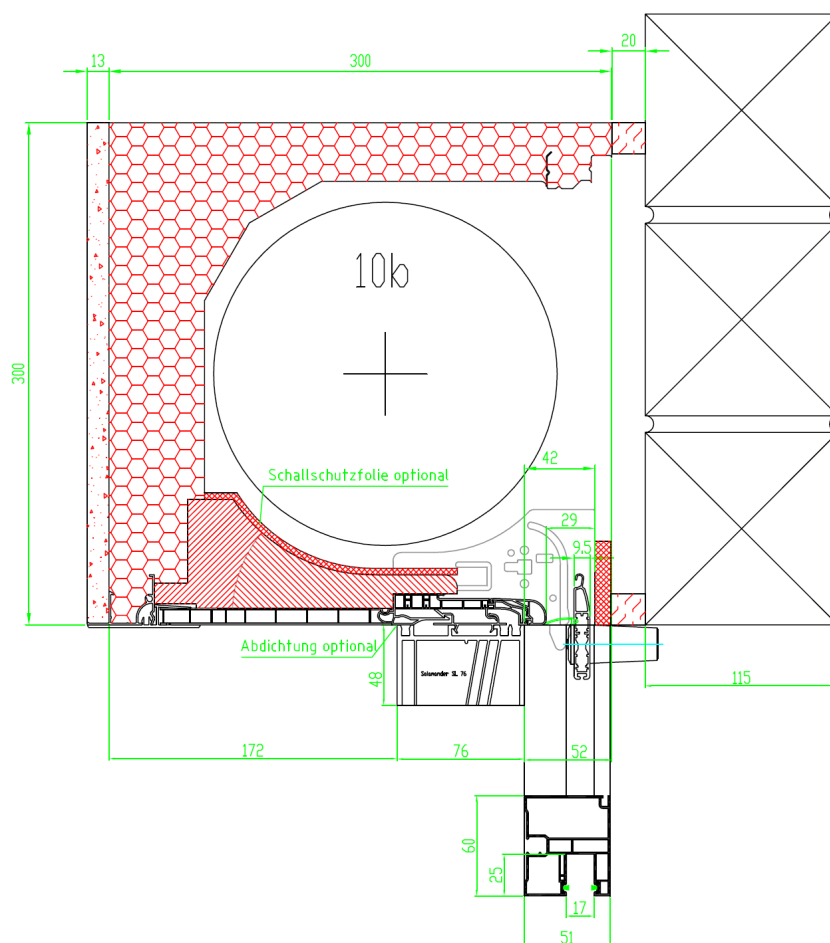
Schnittzeichnung (Grundsatzdetail, Ausführung mit Schallschutzfolie, ohne Abdichtung zum Fensterrahmen, simulierte Klinkerfassade mit $d = 70 \text{ mm}$)
